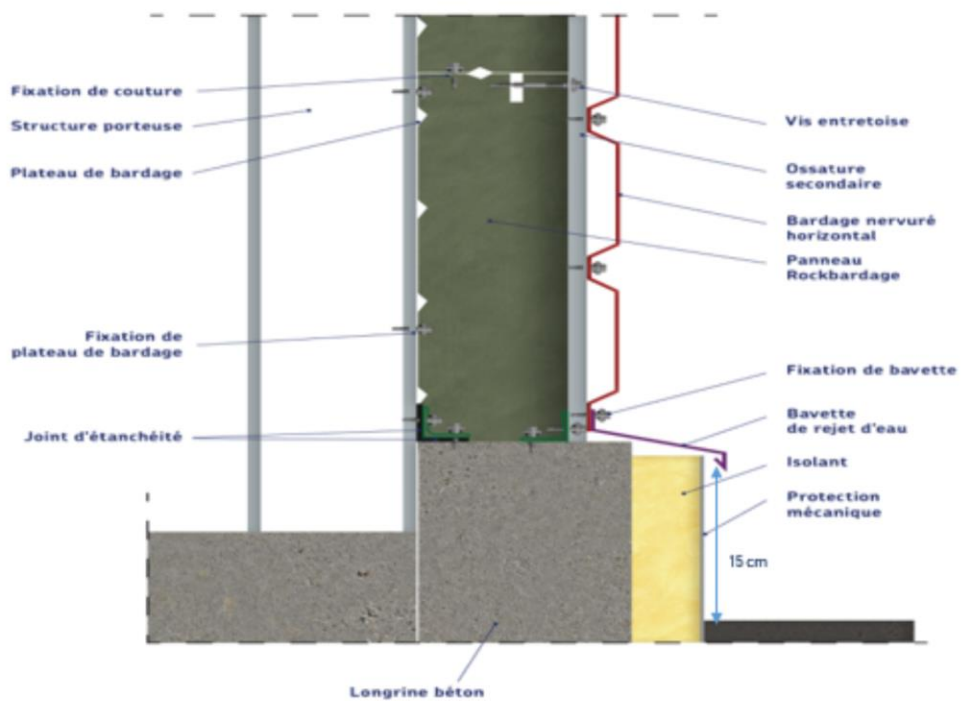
er – Exemple de détail du pied de bardage avec ossature secondaire
